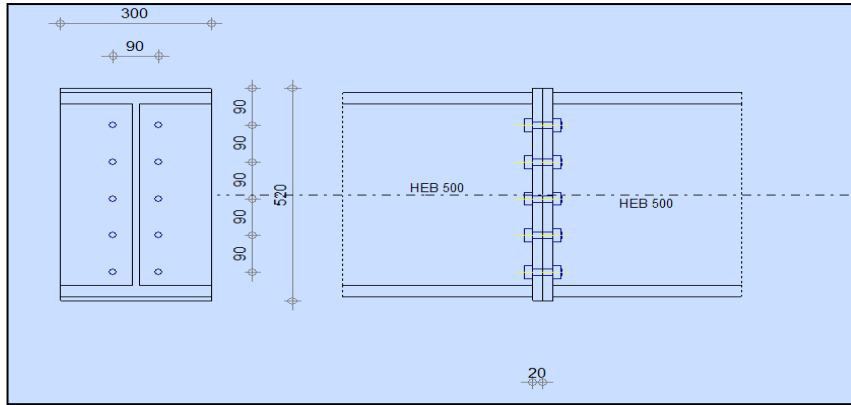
Assemblage poteau-poteau HEB500-HEB500
